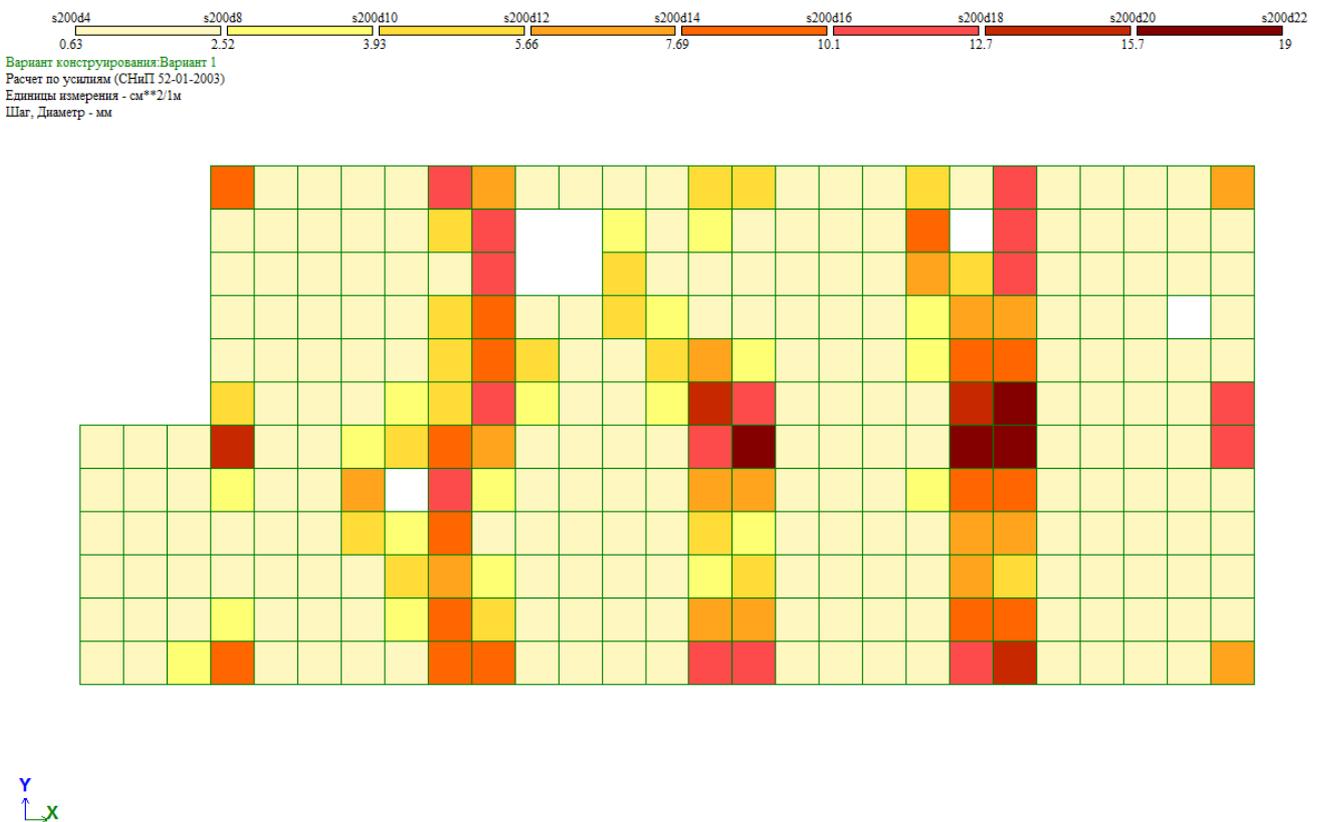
Мозаика площади арматуры монолитной плиты по оси X у верхней грани
